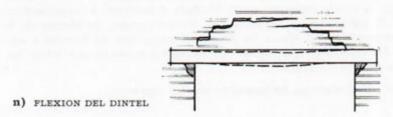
FISURAS EN LOS MUROS DE OBRA DE FABRICA
